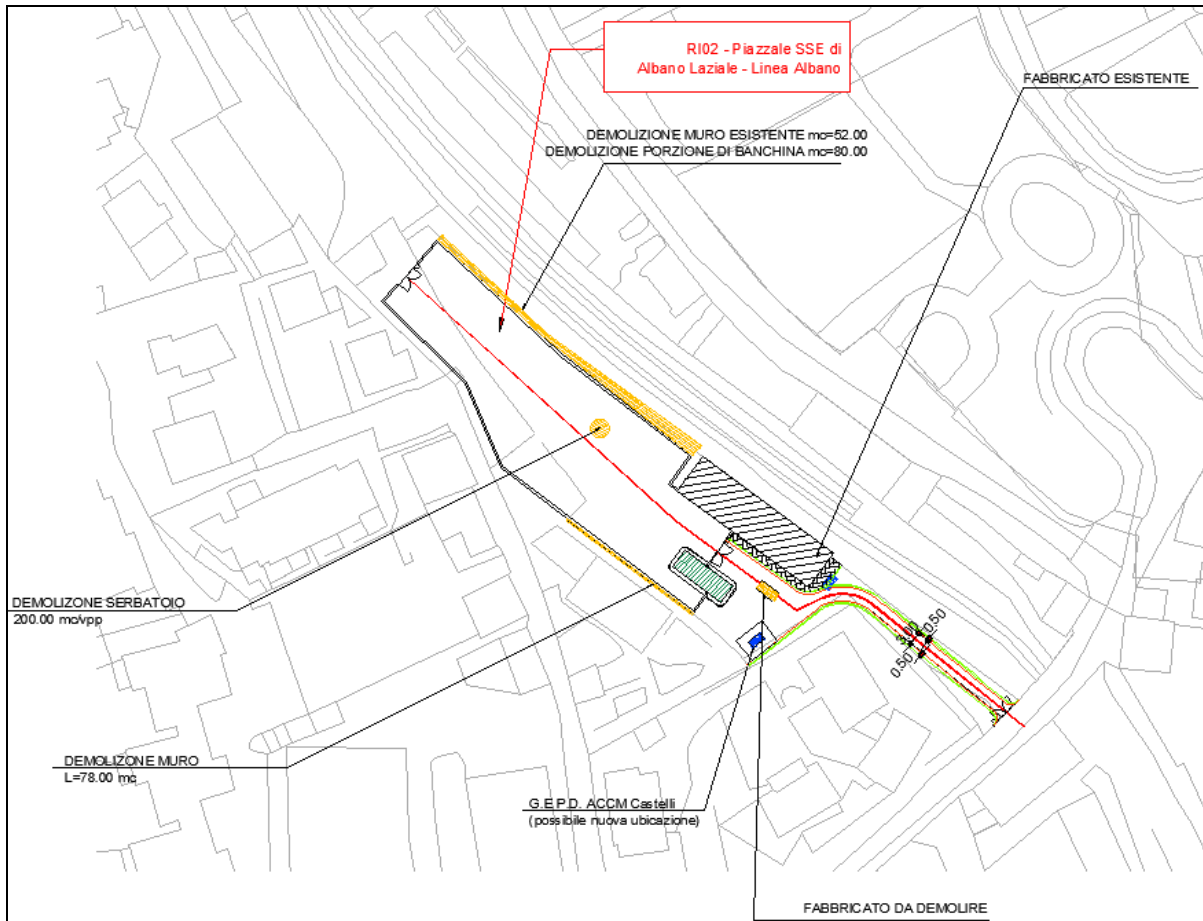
Stralcio planimetrico con evidenza delle demolizioni
